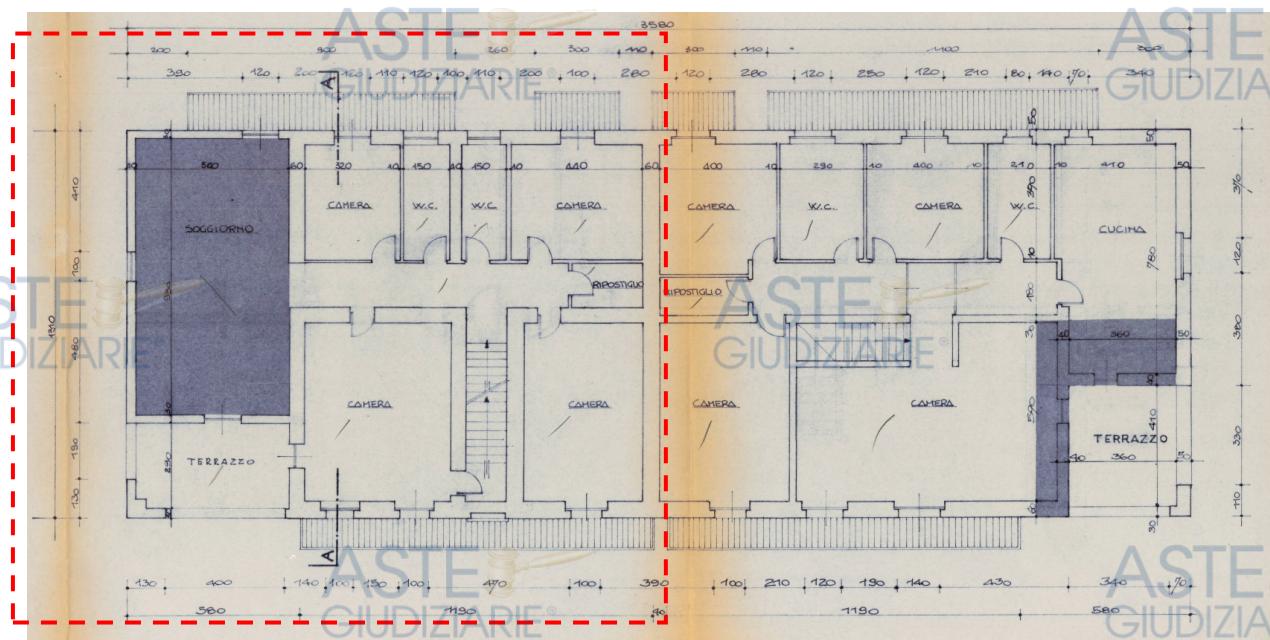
Estratto Concessione in sanatoria ai sensi della Legge 28/2/1985 n.47 n.1517 prot. 20398
